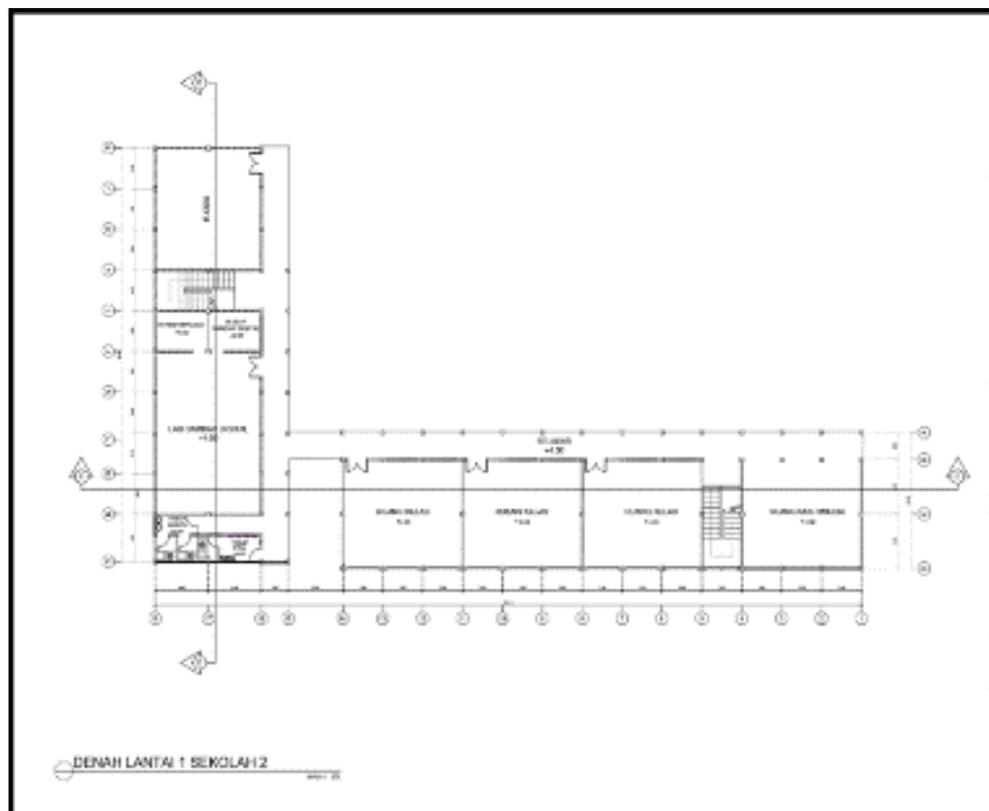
Denah lantai 1 RKB teknik sepeda motor
